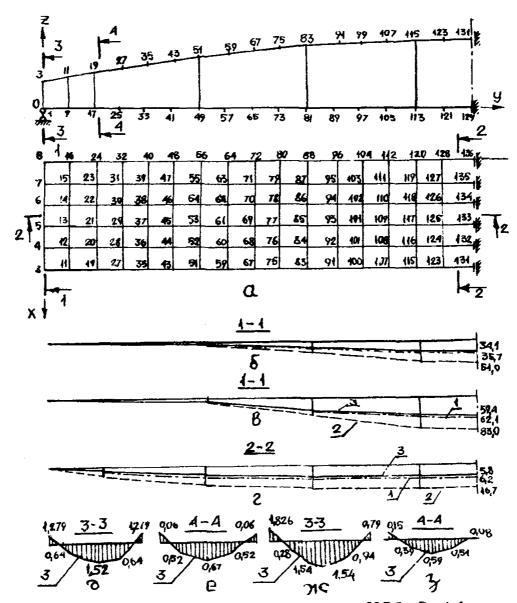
К расчету панели-оболочки КСО 3x24 м а-расчетная схема по методу конечных элементов; и в-прогибы диафрагмы от первого и второго загру-кения (мм); г-прогибы полки от первого загружения, мм; диж-изгибающие элементы в торцовом ребре от первого и второго загружения; е и 3 то же в полке
